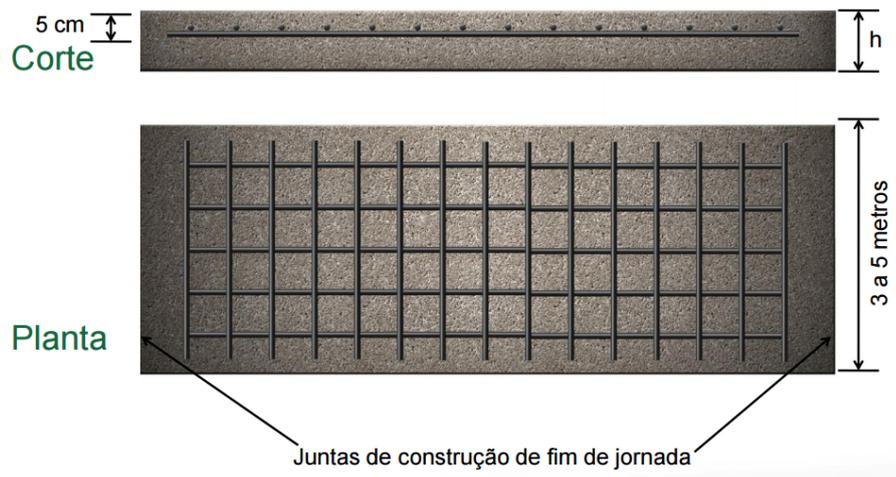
Pavimento de concreto com armadura distribuída contínua
